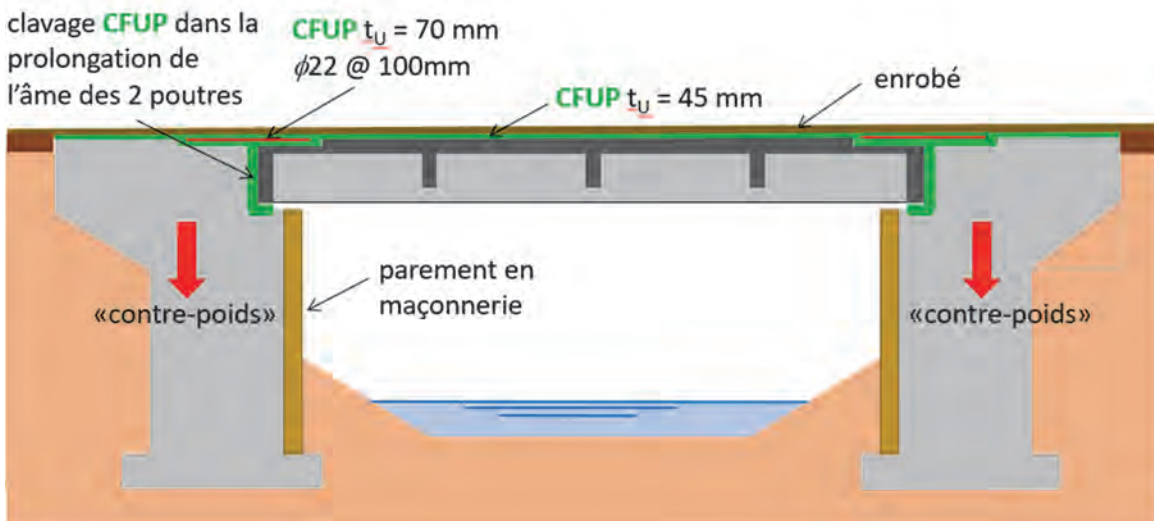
Schéma de l'intervention (renforcement longitudinal)
